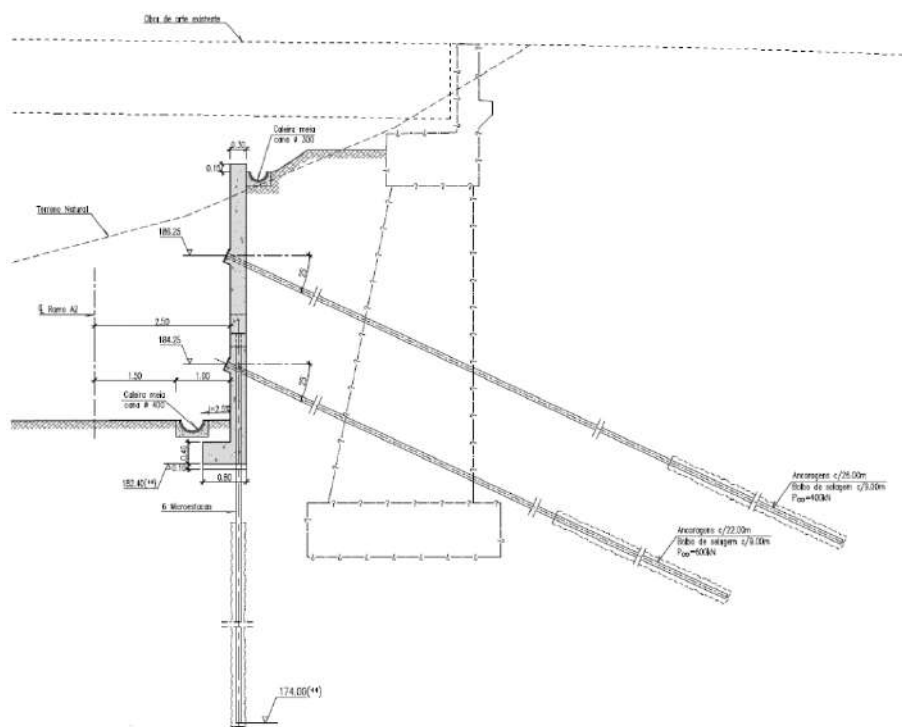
Muro M4 – Secção transversal parede ancorada.
